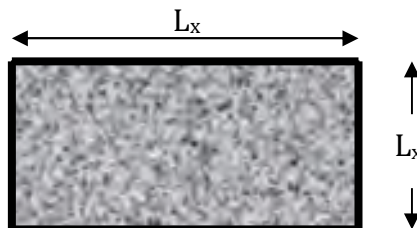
Exemple d'un panneau de dalle sur 4 appuis.
